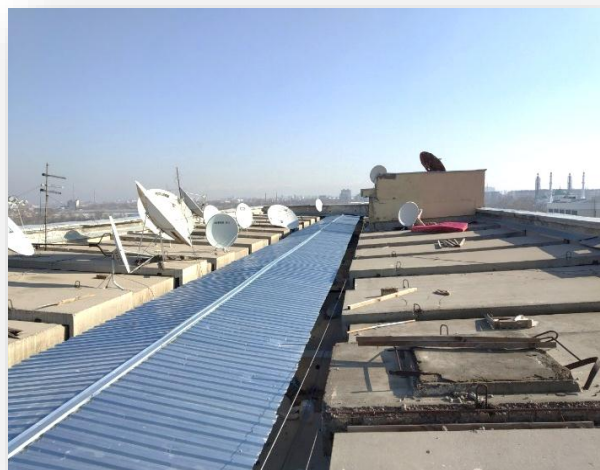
Общий вид девятиэтажного жилого дома с безрулонной крышей.
